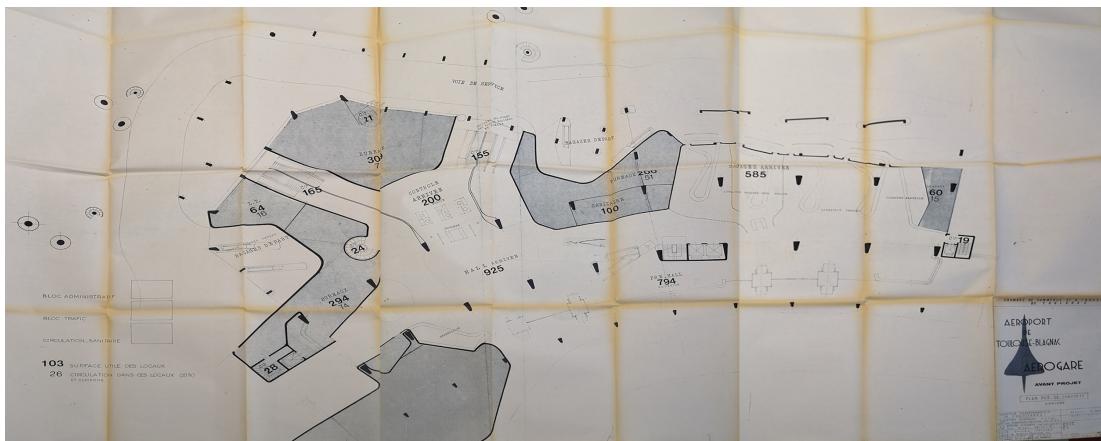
Plan niveau supérieur départ, aérogare de Toulouse-Blagnac 2, architectes : Montier, 1973
